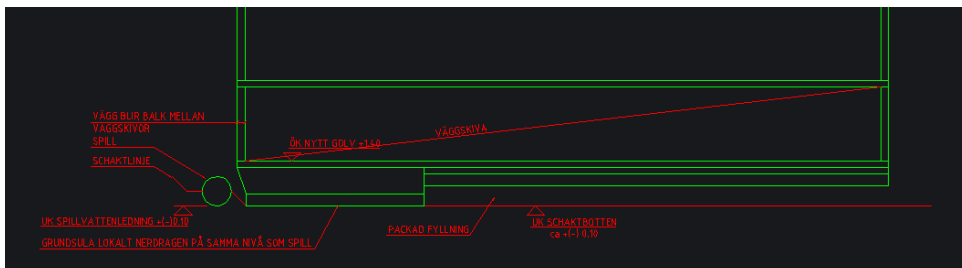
Elevation med exempel på hur byggnadens grund kan utformas för att hantera säkerhetsavståndet till ledningen med plattgrundlagt utförande. Säkerhetsavstånd fastställs i projektering. Bildkälla: WSP
